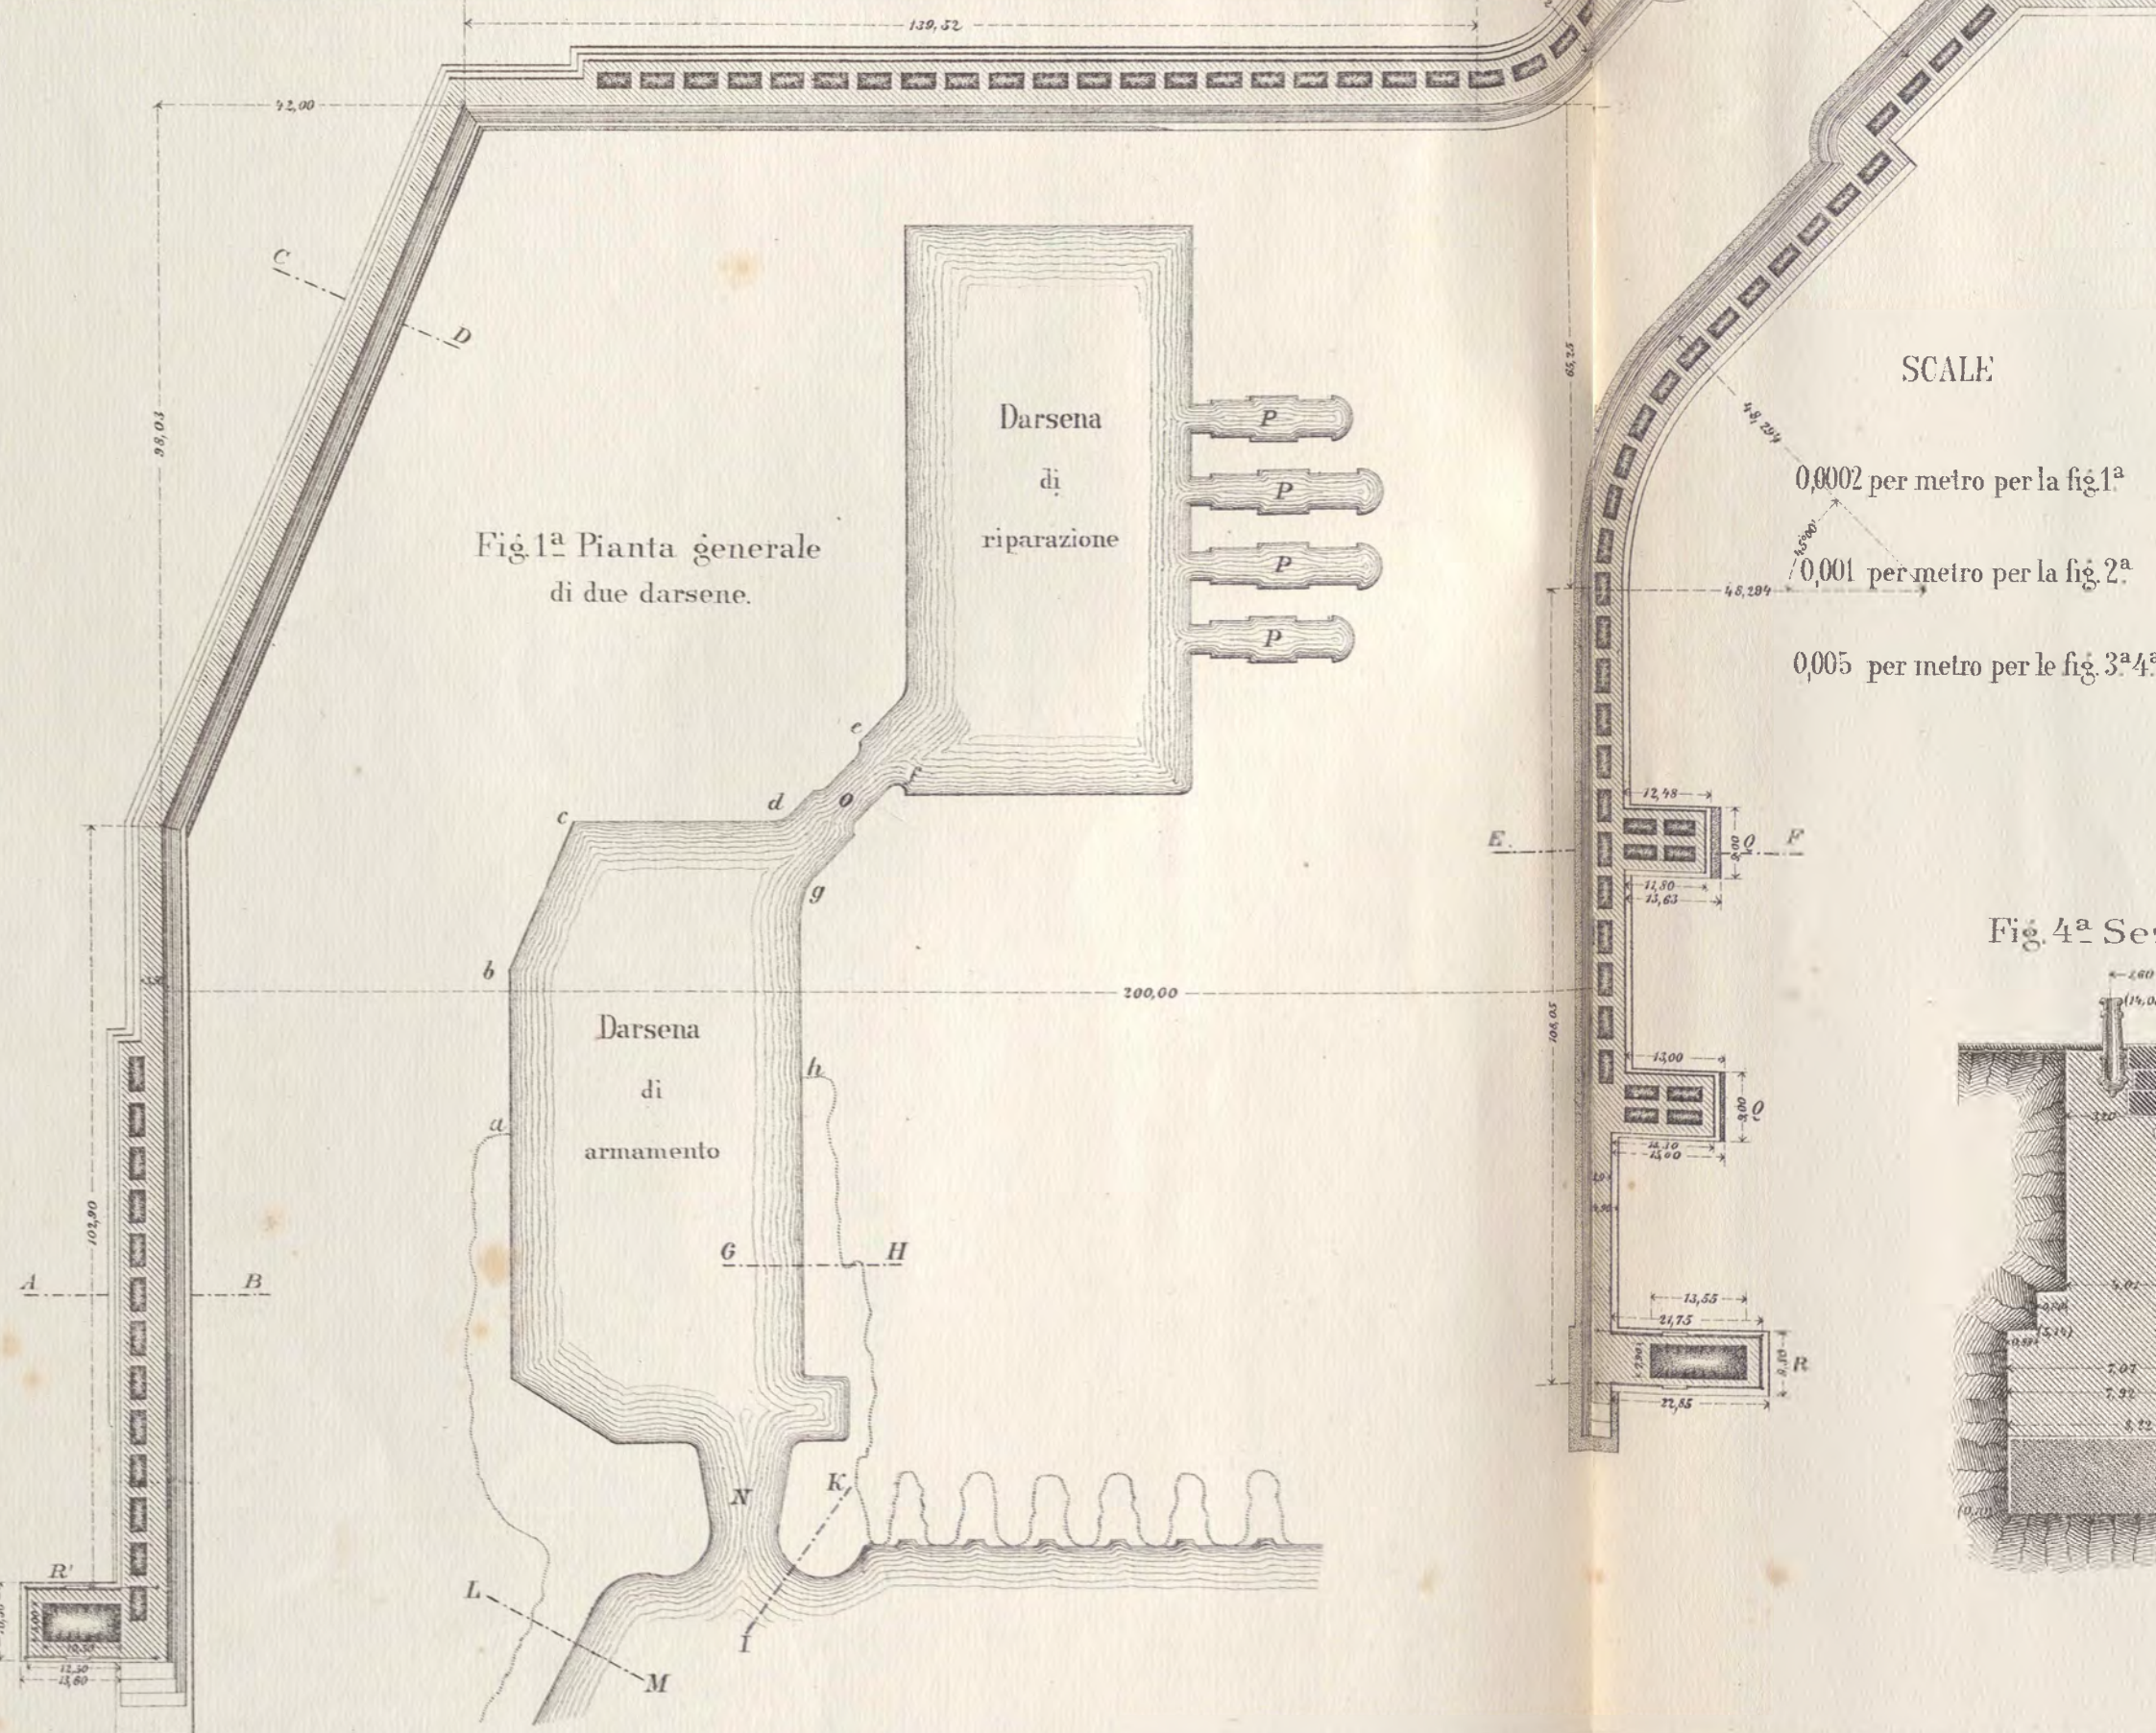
<sup>a</sup> Pianta generale di due darsene.
